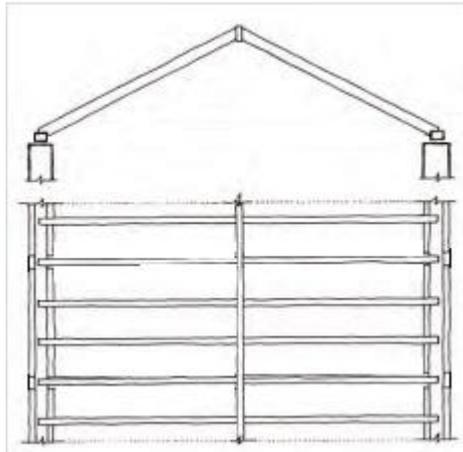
Par e hilera - alzado y planta. 2013. Fuente: Guía de la madera.
